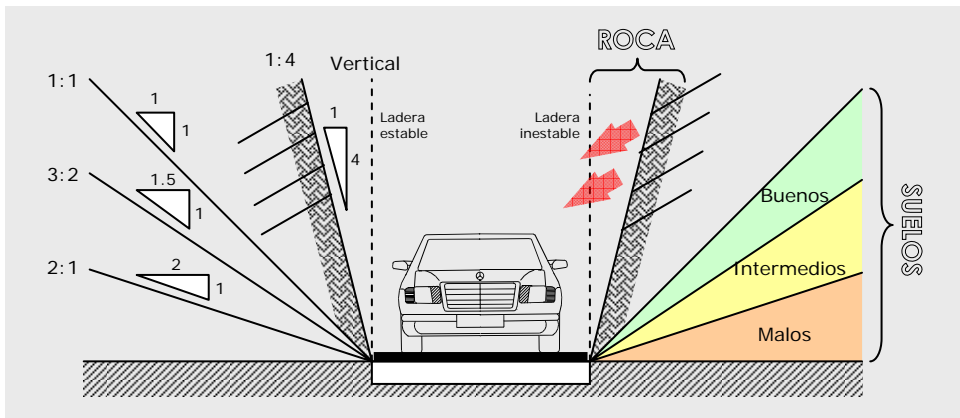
Taludes recomendables en zonas de desmonte
